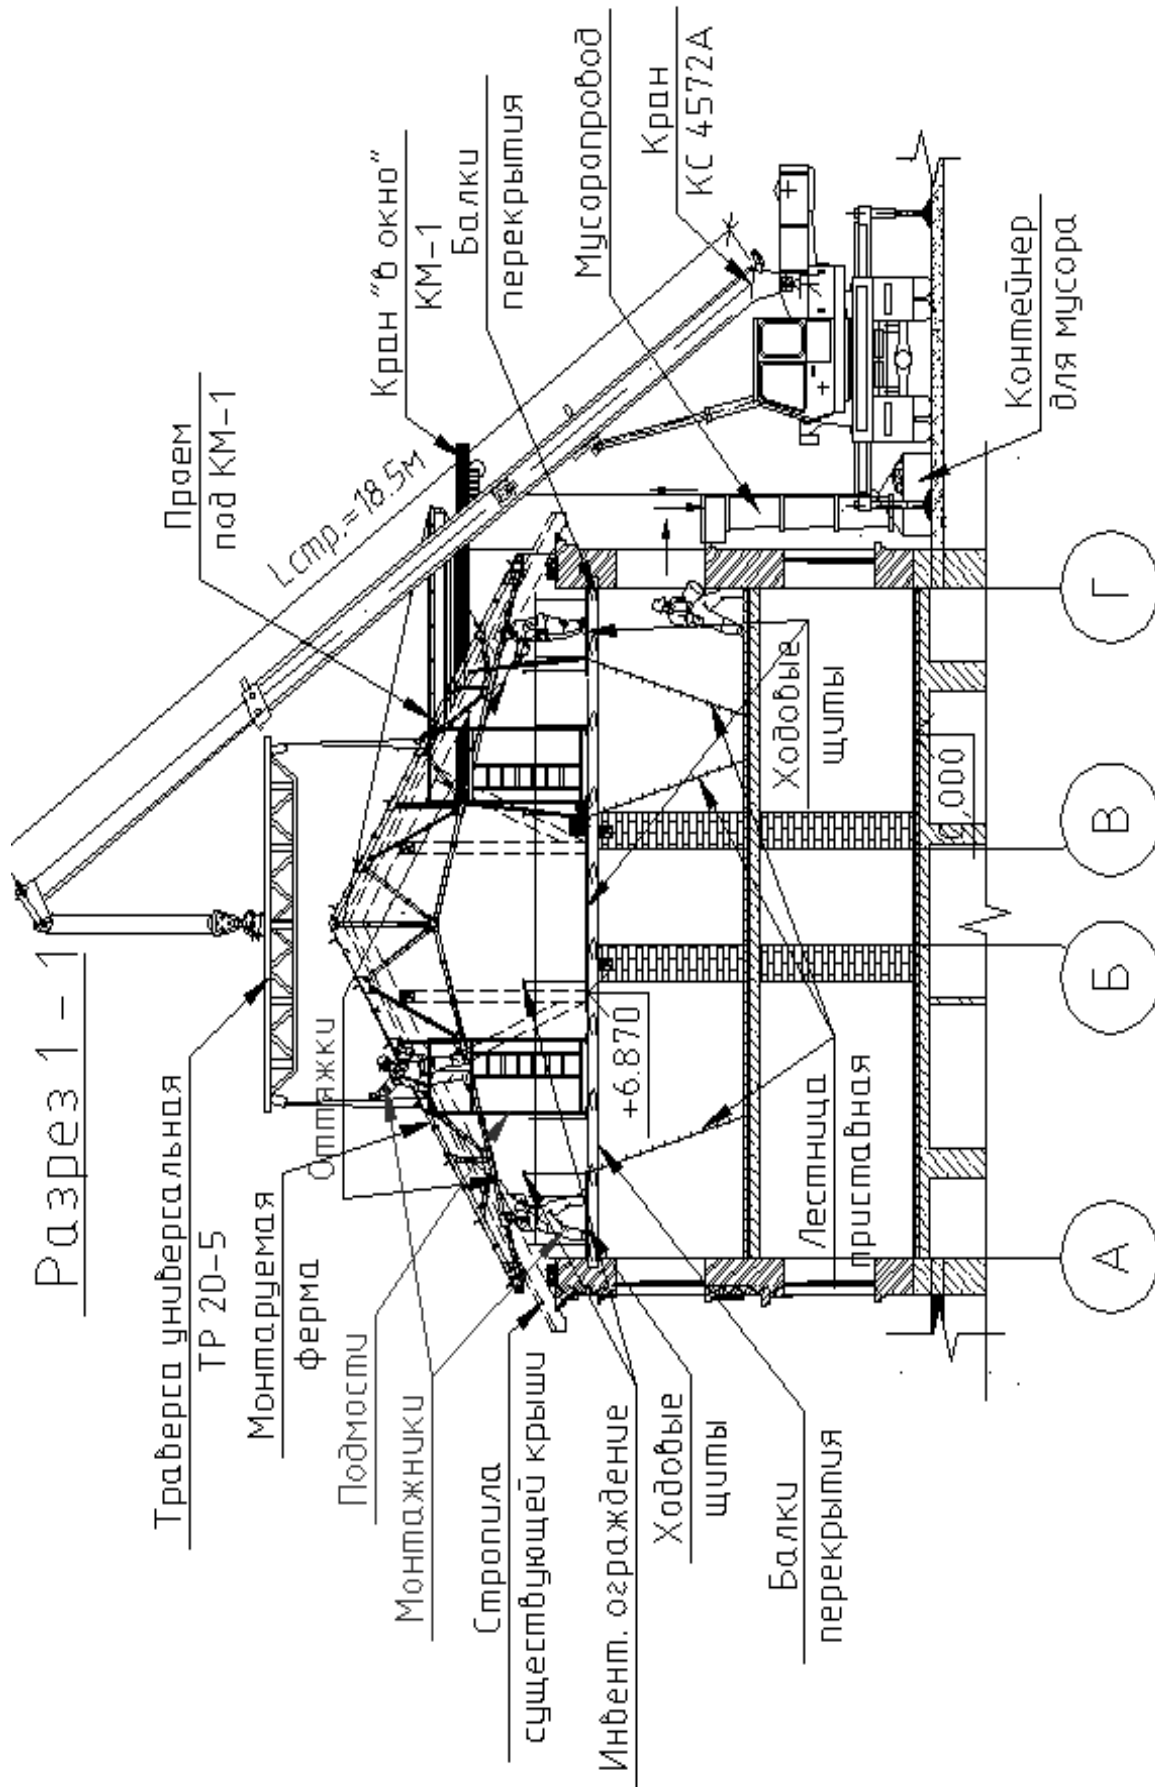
Схема выполнения работ по демонтажу-монтажу конструкций покрытия.
